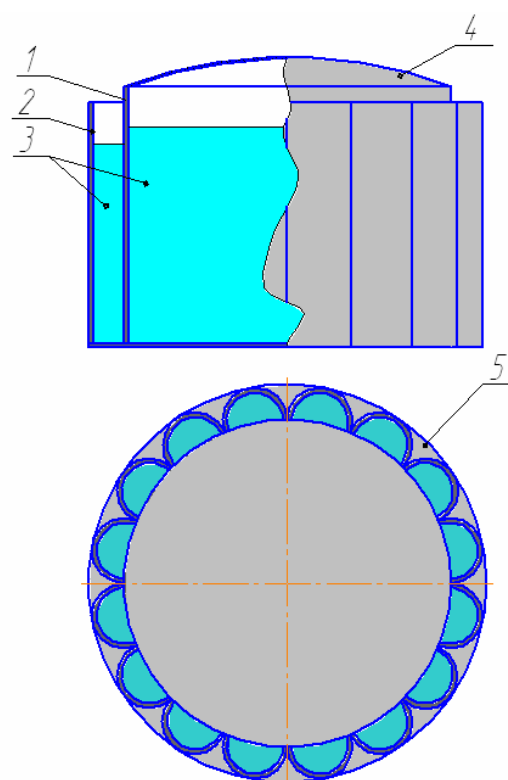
Общий вид и вид сверху «лепесткового» резервуара: 1 – центральный резервуар; 2 – «лепесток»; 3 – жидкость; 4 – крыша; 5 – днище
